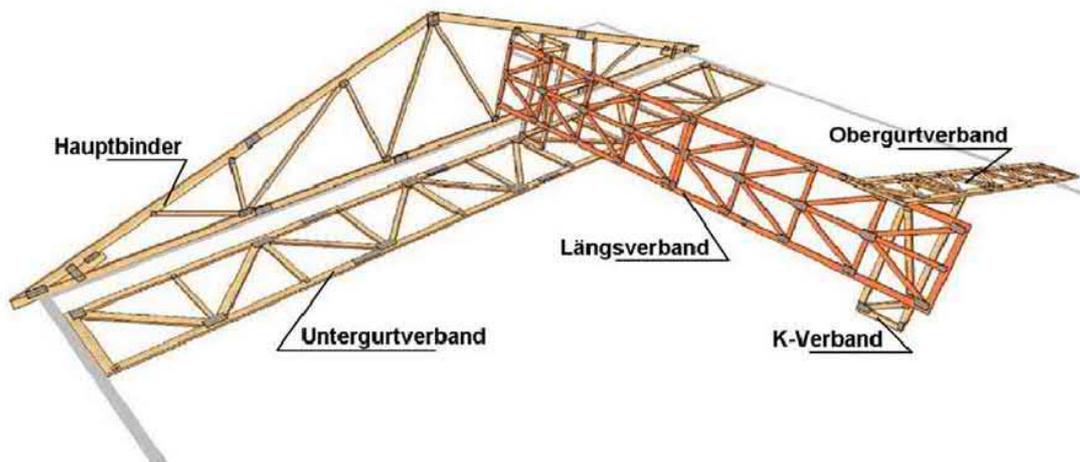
Isometrie Dachstuhl (Beispiel) mit stehendem Längsverband
